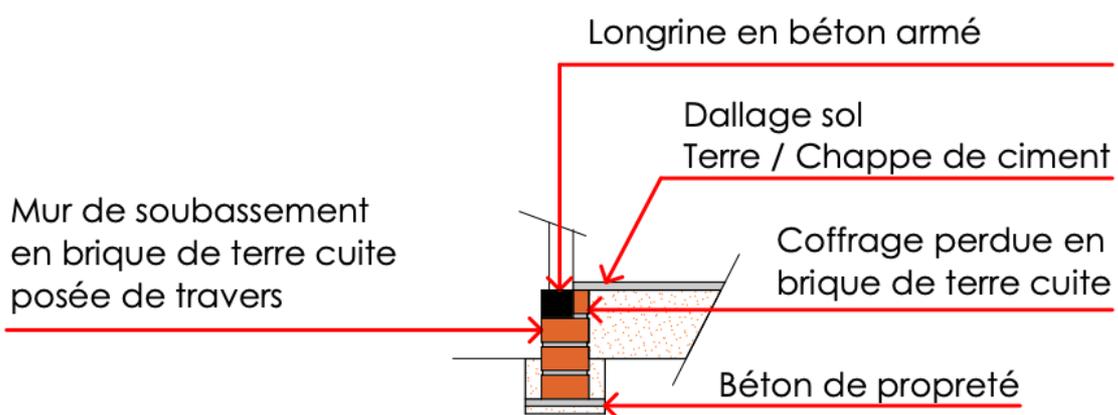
Détail d'une fondation en semelles filantes en briques de terre cuite d'une maison semi-dure
